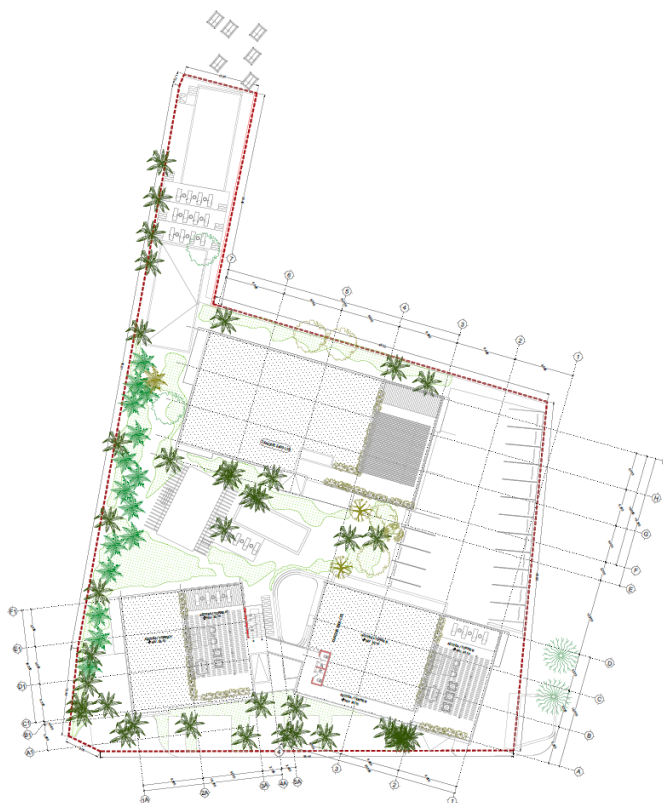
Planta Nivel azotea de la Torre A y Torre B
